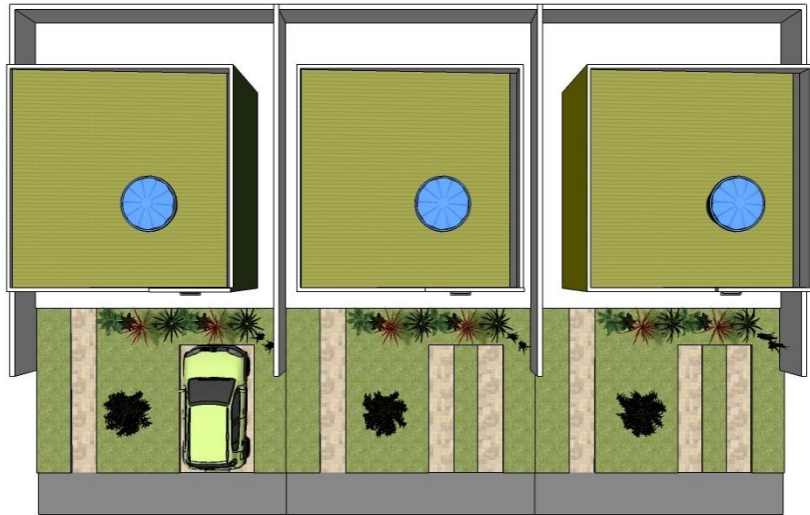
Planta humanizada - casas modelo 34,69m² - telhado 01 água.
